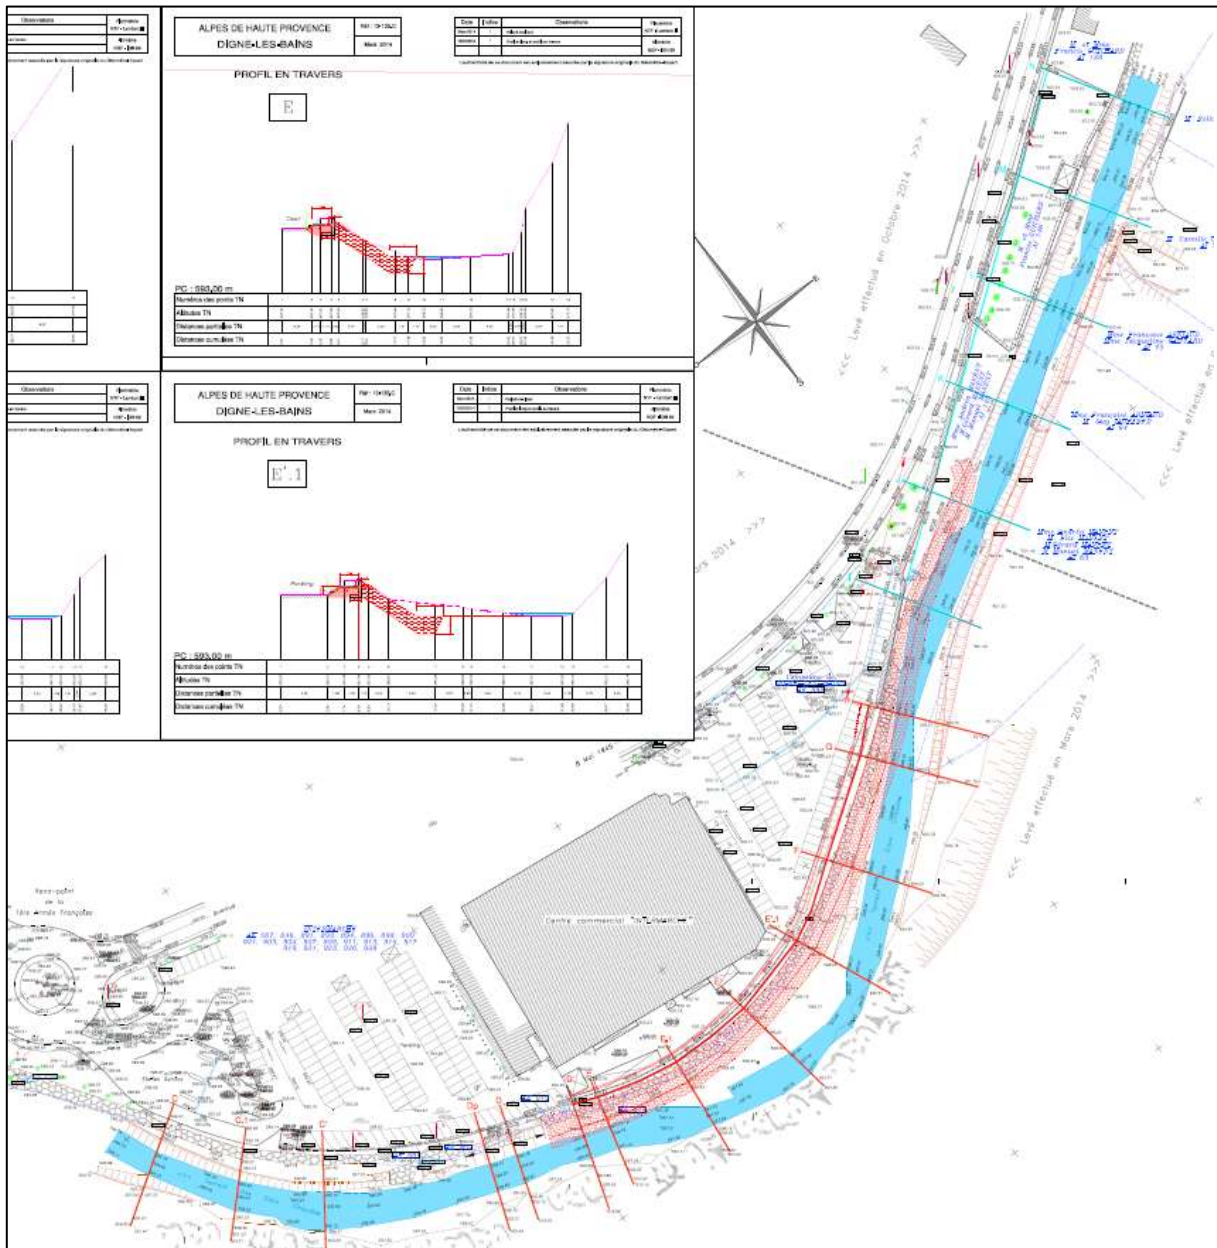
Extrait de la vue en plan de l'avant-projet Hydretudes (voir fichier original en annexe 4)
